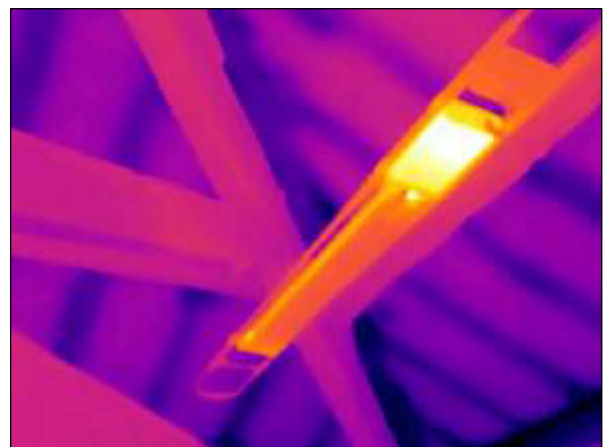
Individuazione della tramatura caratteristica dell'intradosso dell'Ufficio 1 al piano secondo.
